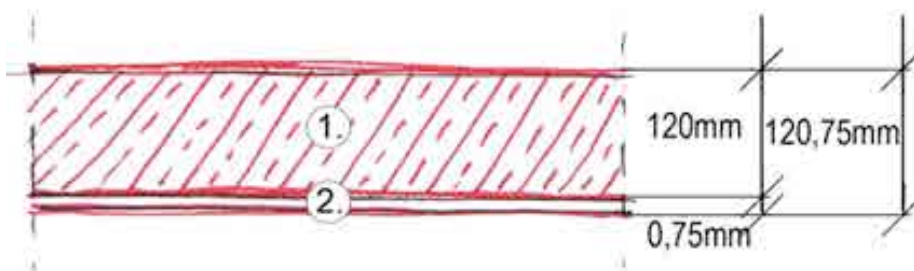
Durchschnittliche Betonmenge, = 120mm Beton Bestand und Blech 0,75mm \_ Decke Trapezblech 14cm
